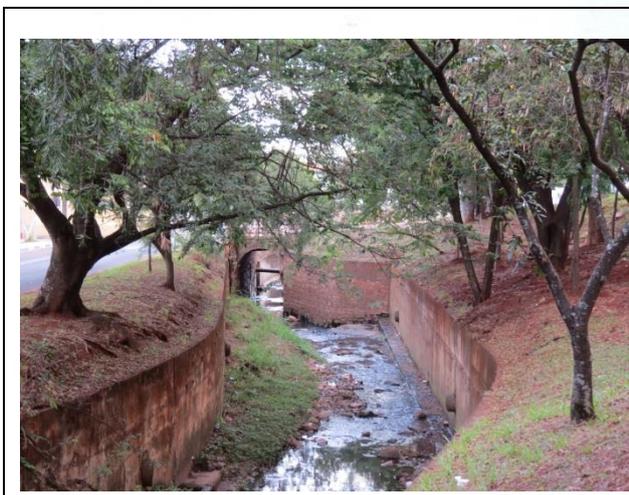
Vista de local, córrego Gregório, onde há forte estrangulamento da drenagem. Segundo a COMDEC, há projeto de ampliação do canal a ser financiado pela Defesa Civil do estado.
